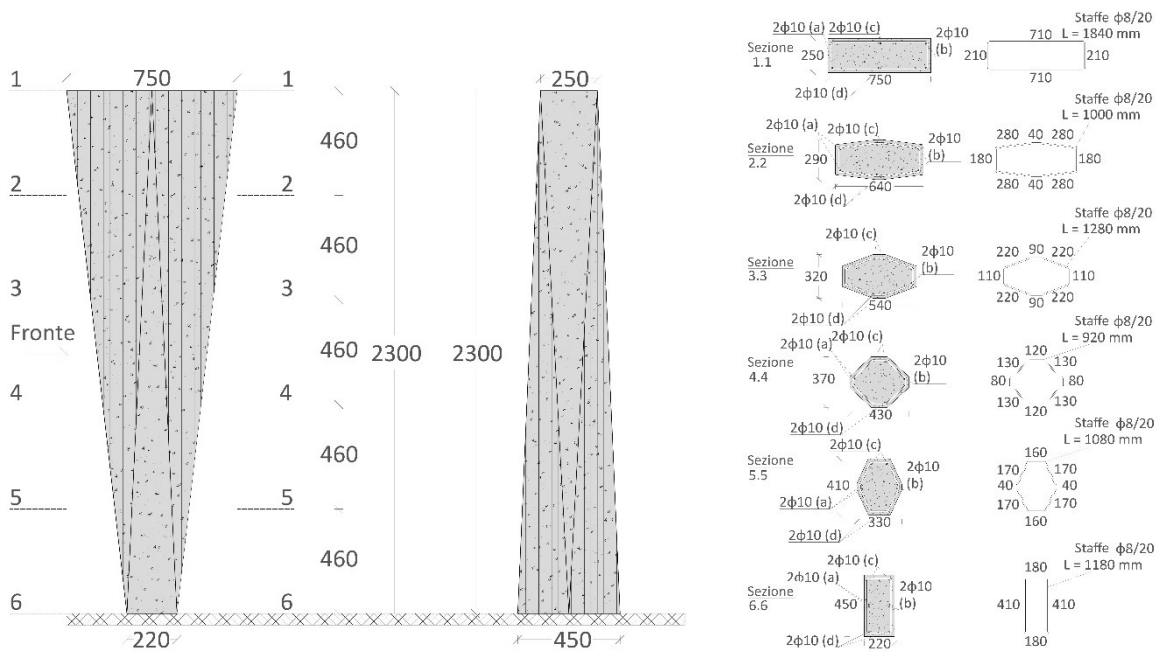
Prospetti e sezioni dei quattro pilastri a sezione variabile collocati centralmente
